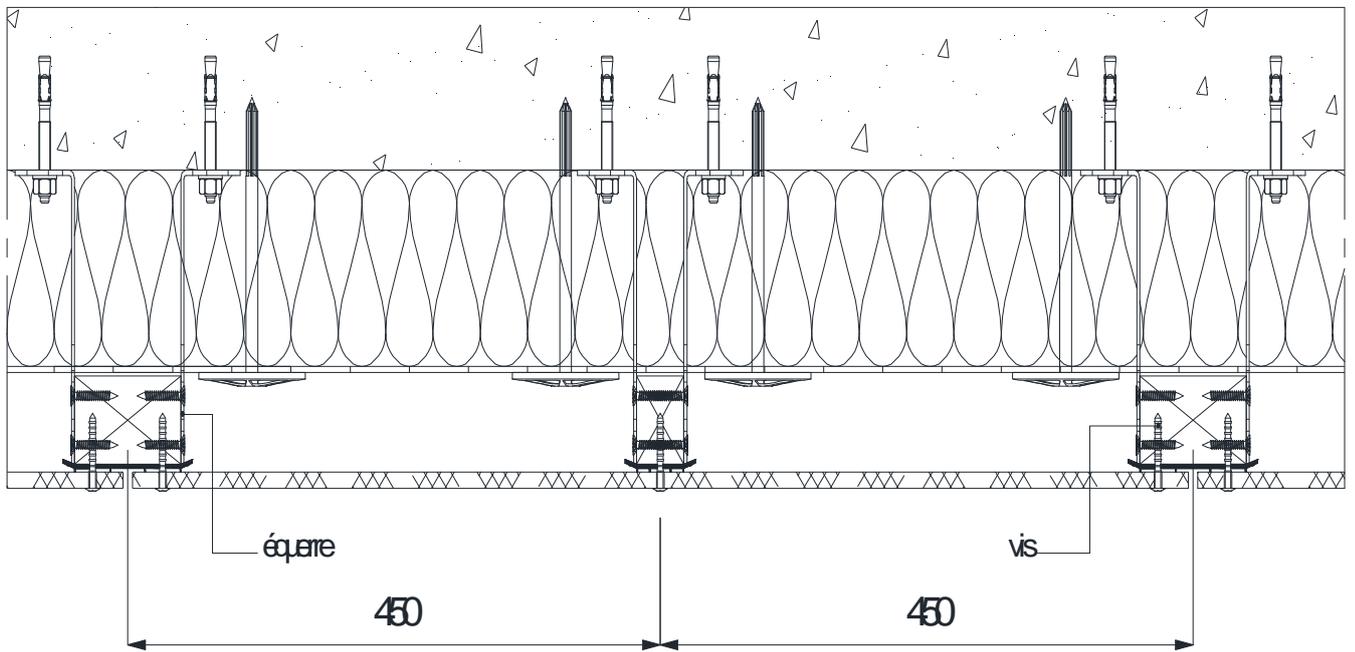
Pose en sous-face et inclinée (cote en mm)
